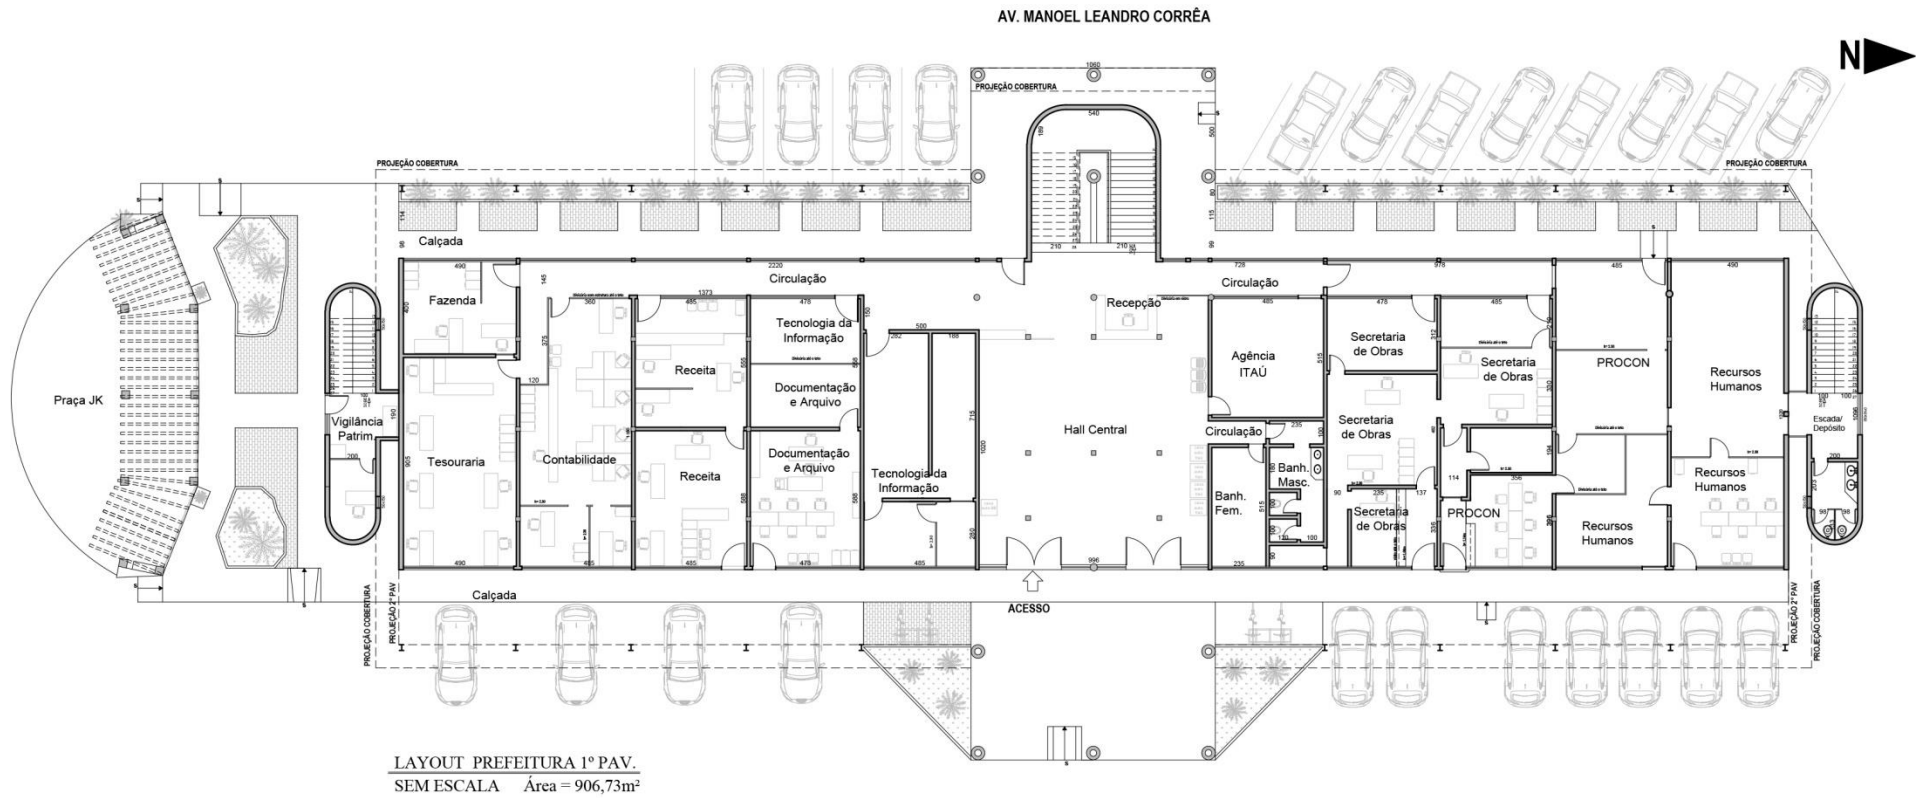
Planta Baixa com layout do Primeiro Pavimento da Prefeitura Municipal
